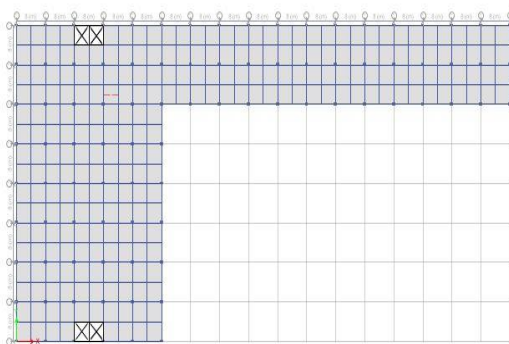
Denah Lantai 5 - Lantai 8 Model A2
